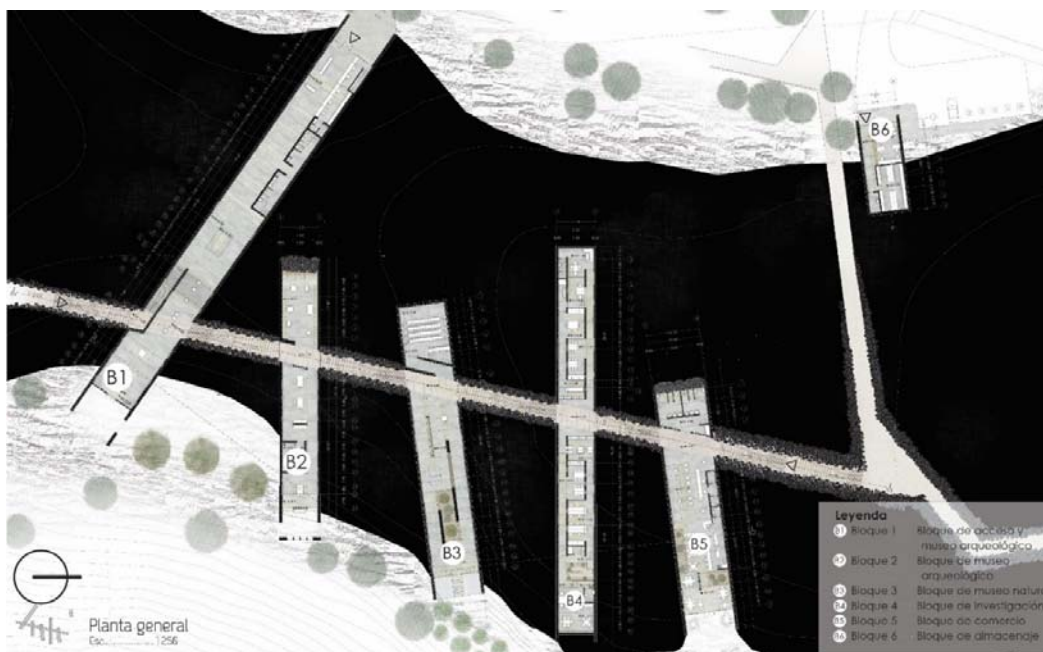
Planta de cubiertas y planta baja general (Silva D., 2017)
